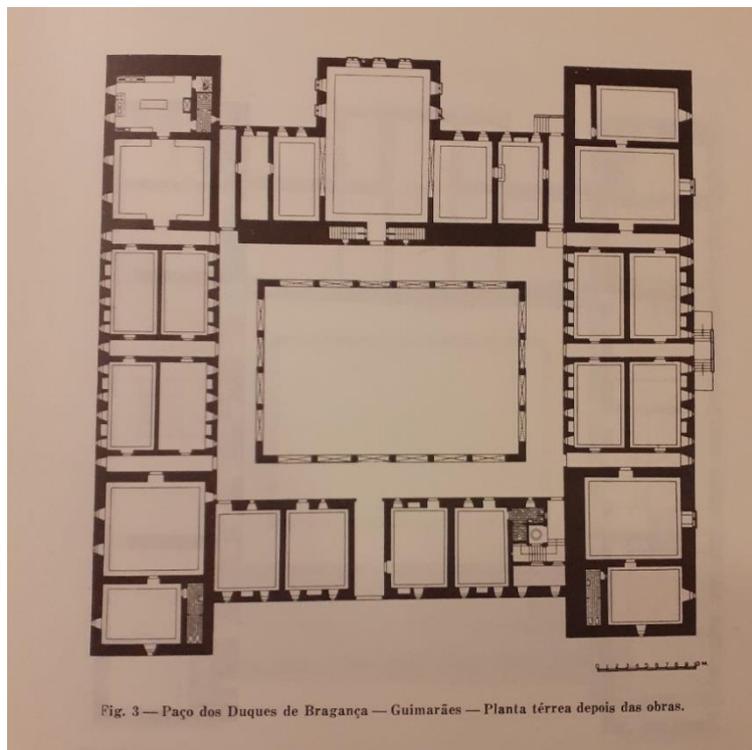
Planta do piso térreo do Paço dos Duques de Bragança após o restauro.
